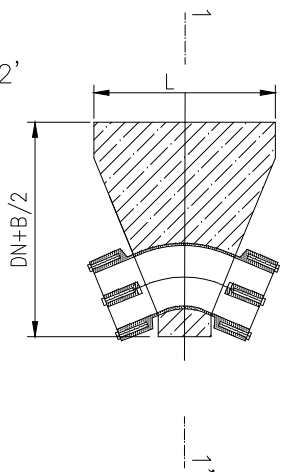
DETAIL ZAJIŠŤOVACÍCH OPĚRNÝCH BLOKŮ
